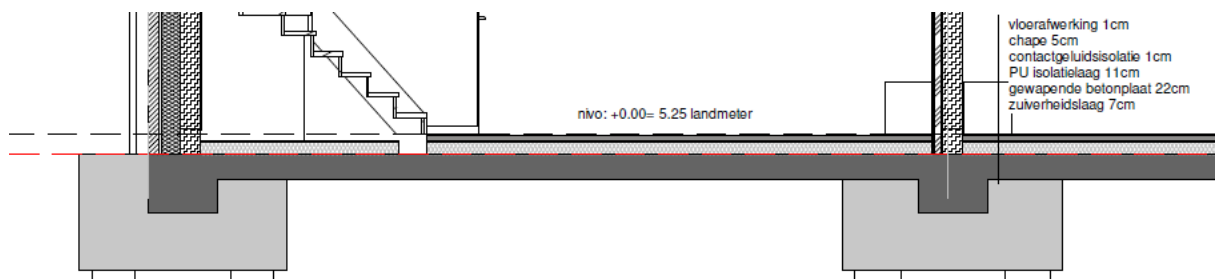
Funderingsplan gebouw D. (Plan aangeleverd door architect B2A1).
